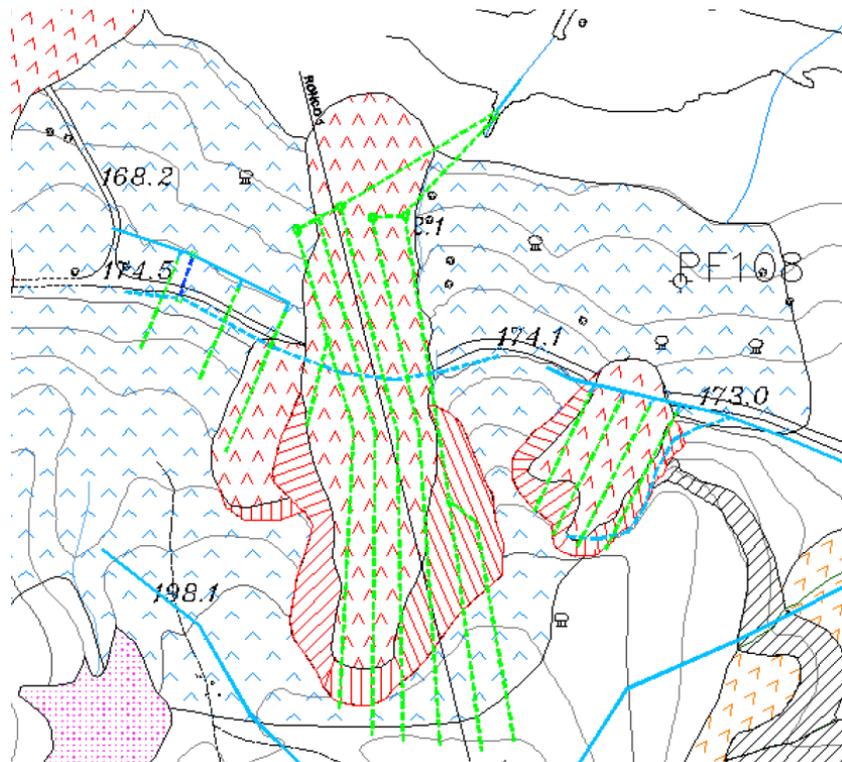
MA-10 - Ronco: Planimetria degli interventi e tracciato delle trincee drenanti.
